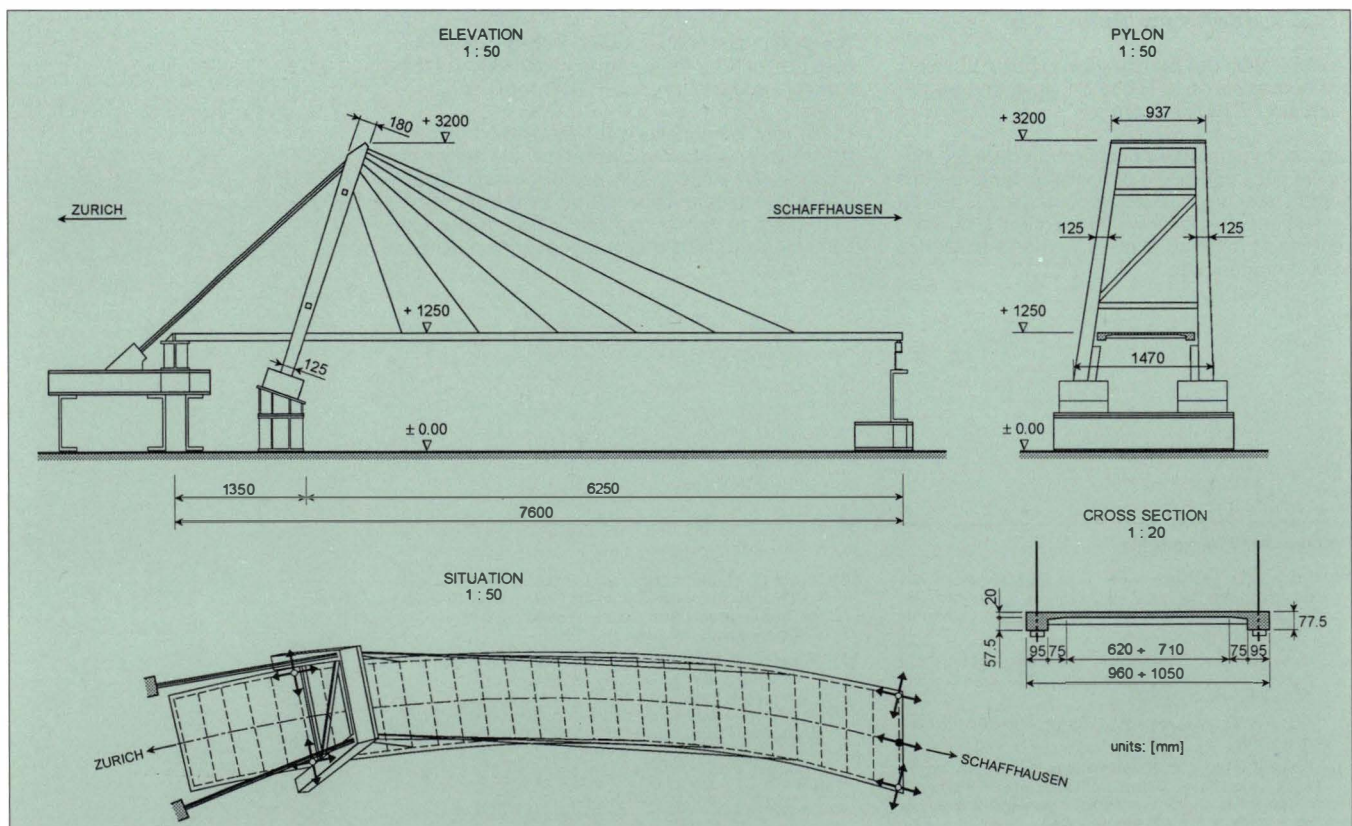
Plan d'ensemble de la maquette du pont haubané courbe sur le Rhin à Schaffhouse
